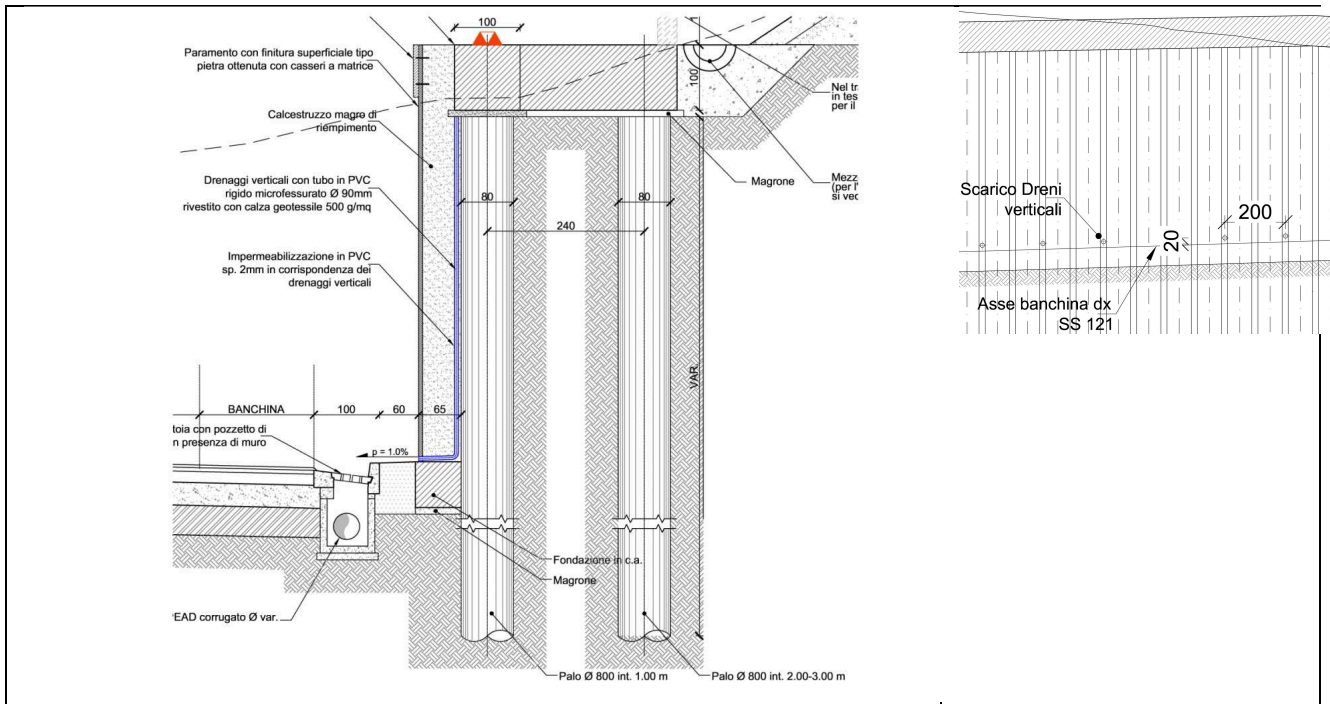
Sezione tipo e stralci di prospetto con dreni verticali, come da soluzione PEA
